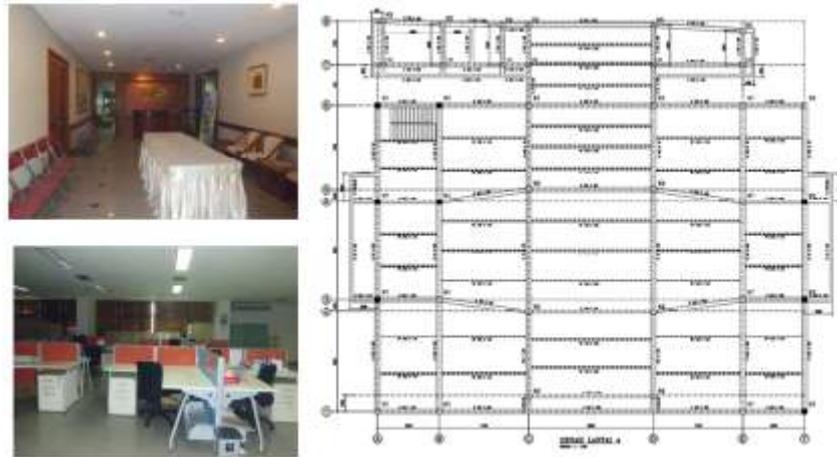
Denah Lantai 1 dan tampak luar KCP A. Rivai
